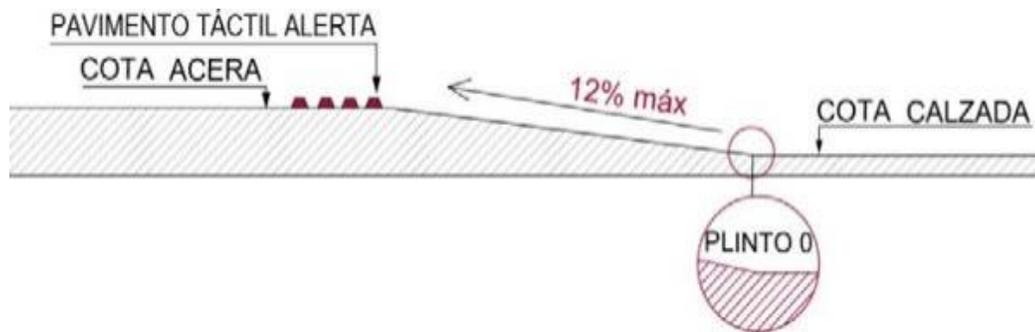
Detalle de encuentro de la rampa entre vereda y calzada.
